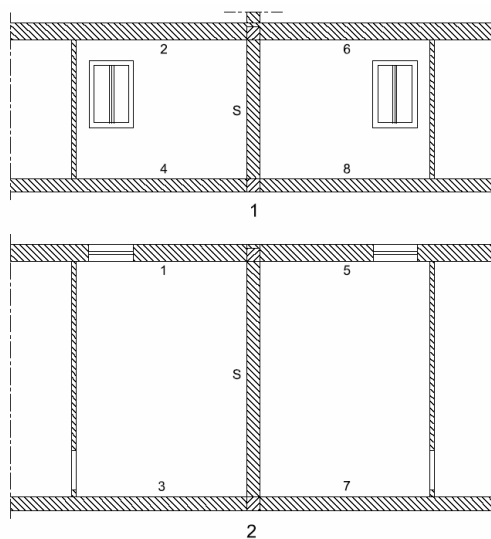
Codifica degli elementi strutturali dei due ambienti in pianta e sezione
